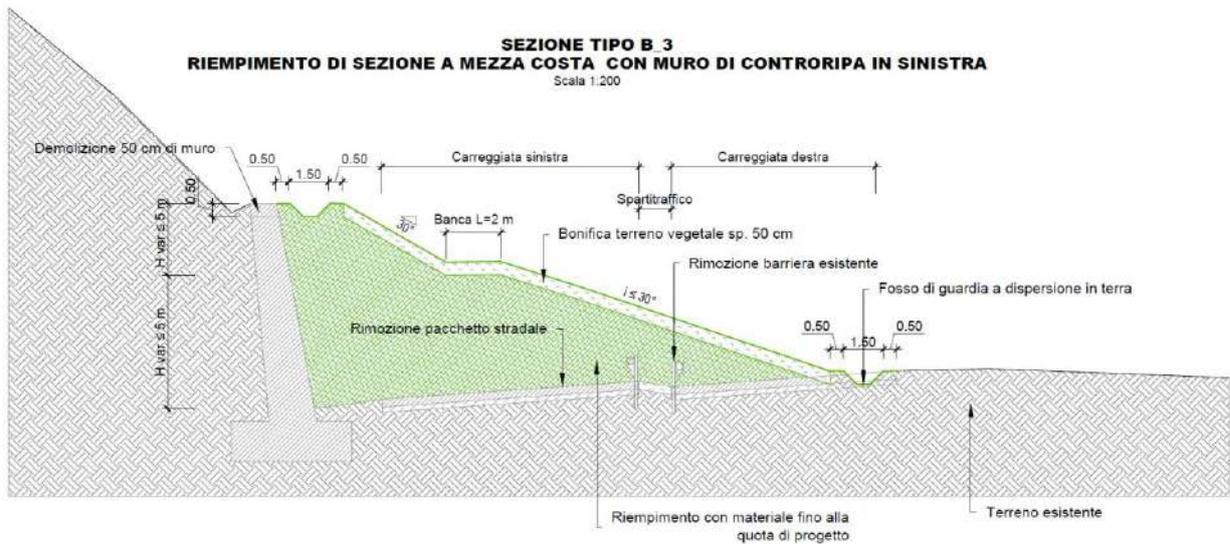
Sezione tipo B_3 riempimento mezza costa con muro in sinistra
